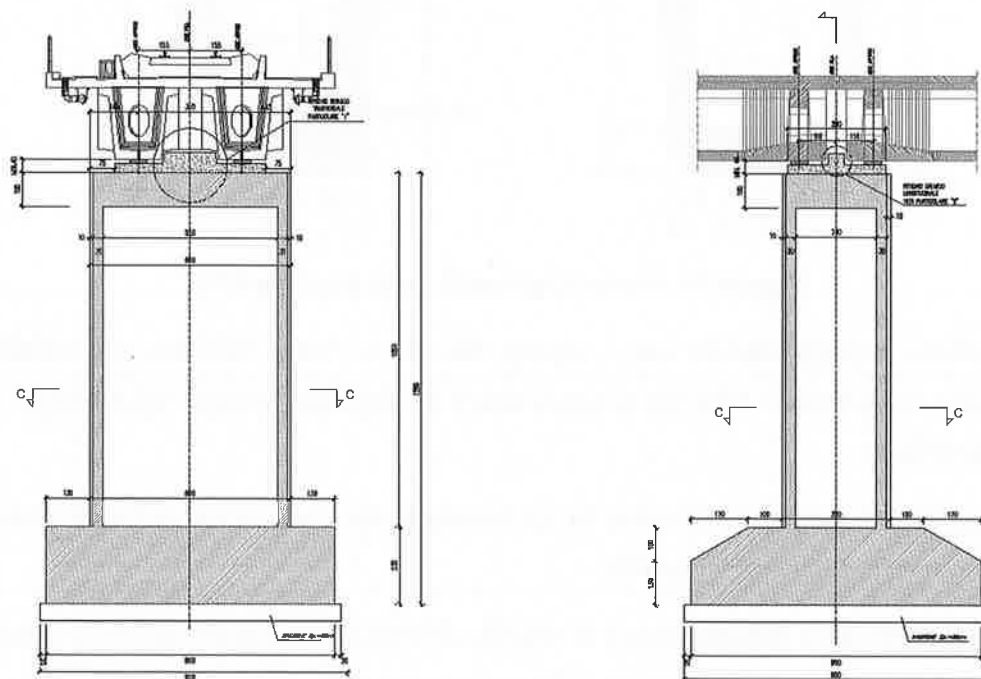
Sezioni verticali pila H < 11m, Bauladu VI02
